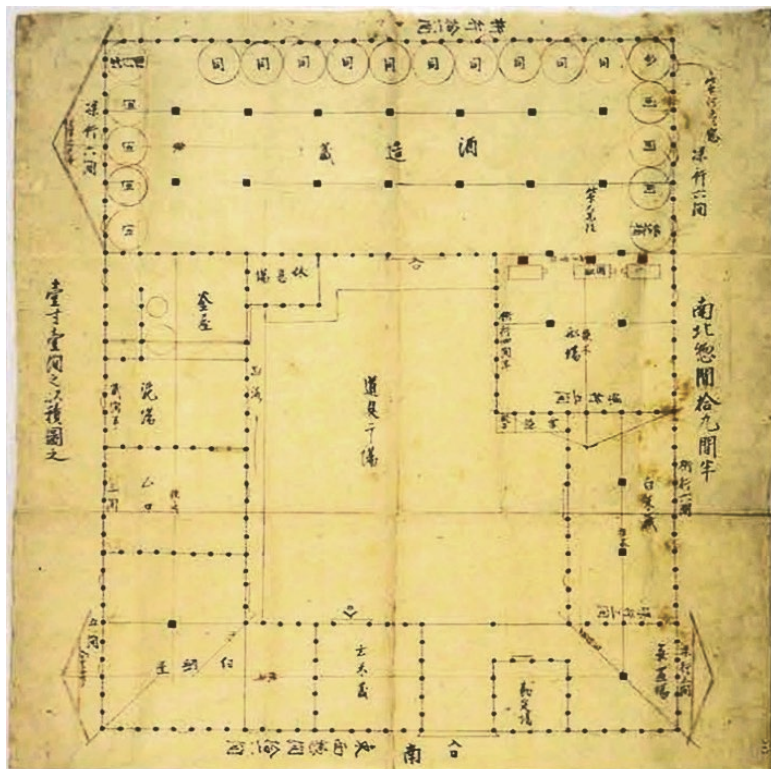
天保期、千石造りの酒蔵の平面図 (本嘉納家所蔵)
